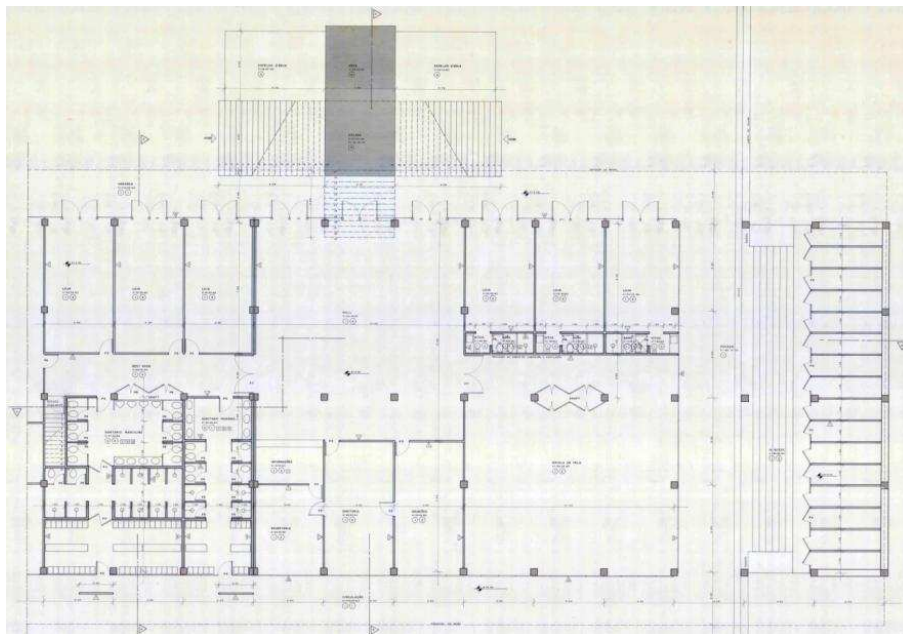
5º Estudo, Planta baixa seção A (Desenhos de Amaro Machado, Arquivo do NPD)
